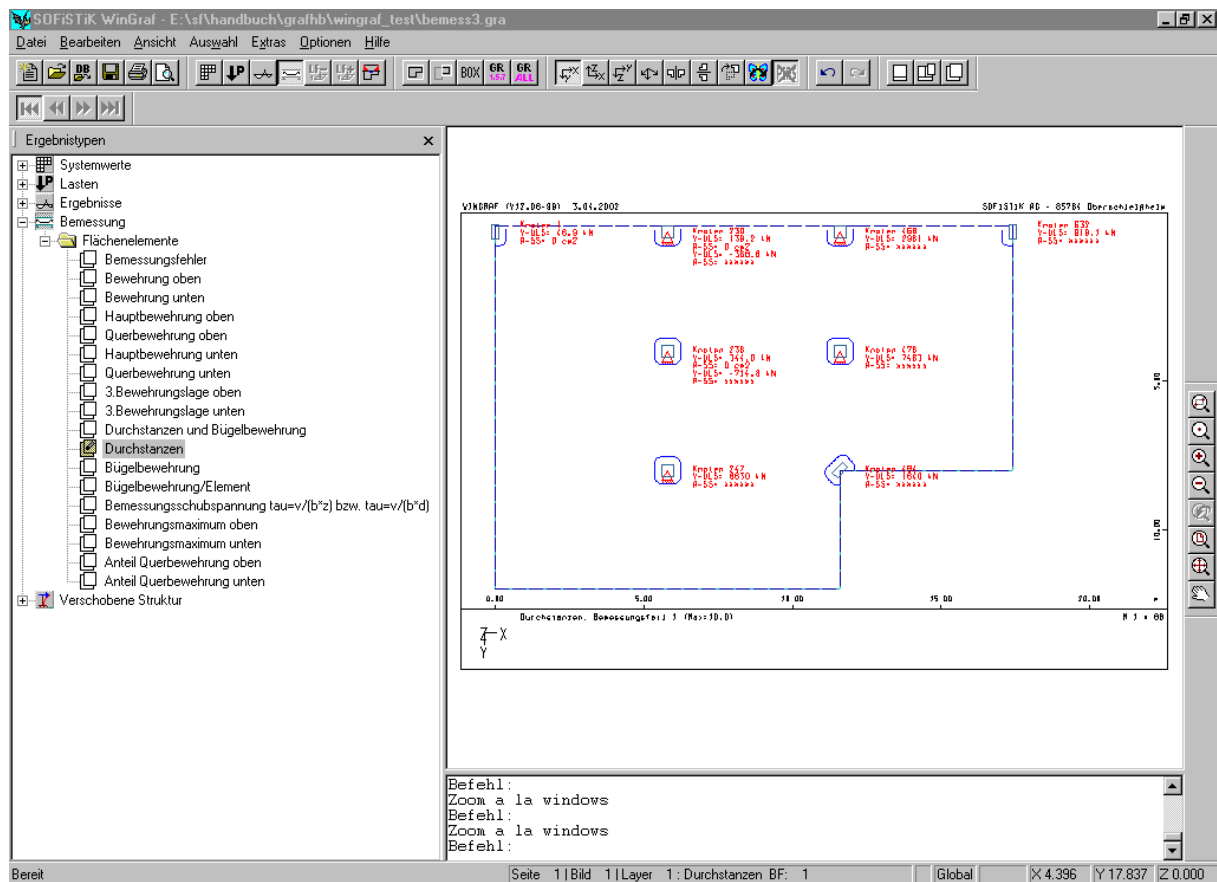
Durchstanznachweise und –bemessung einer Platte – Bemessungsfall 1
